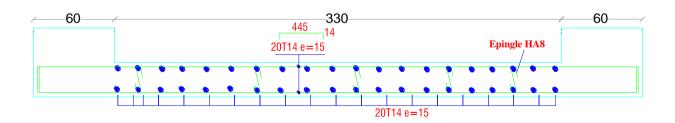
Coupe horizontale de Ferraillage des voiles au niveau de RDC.
